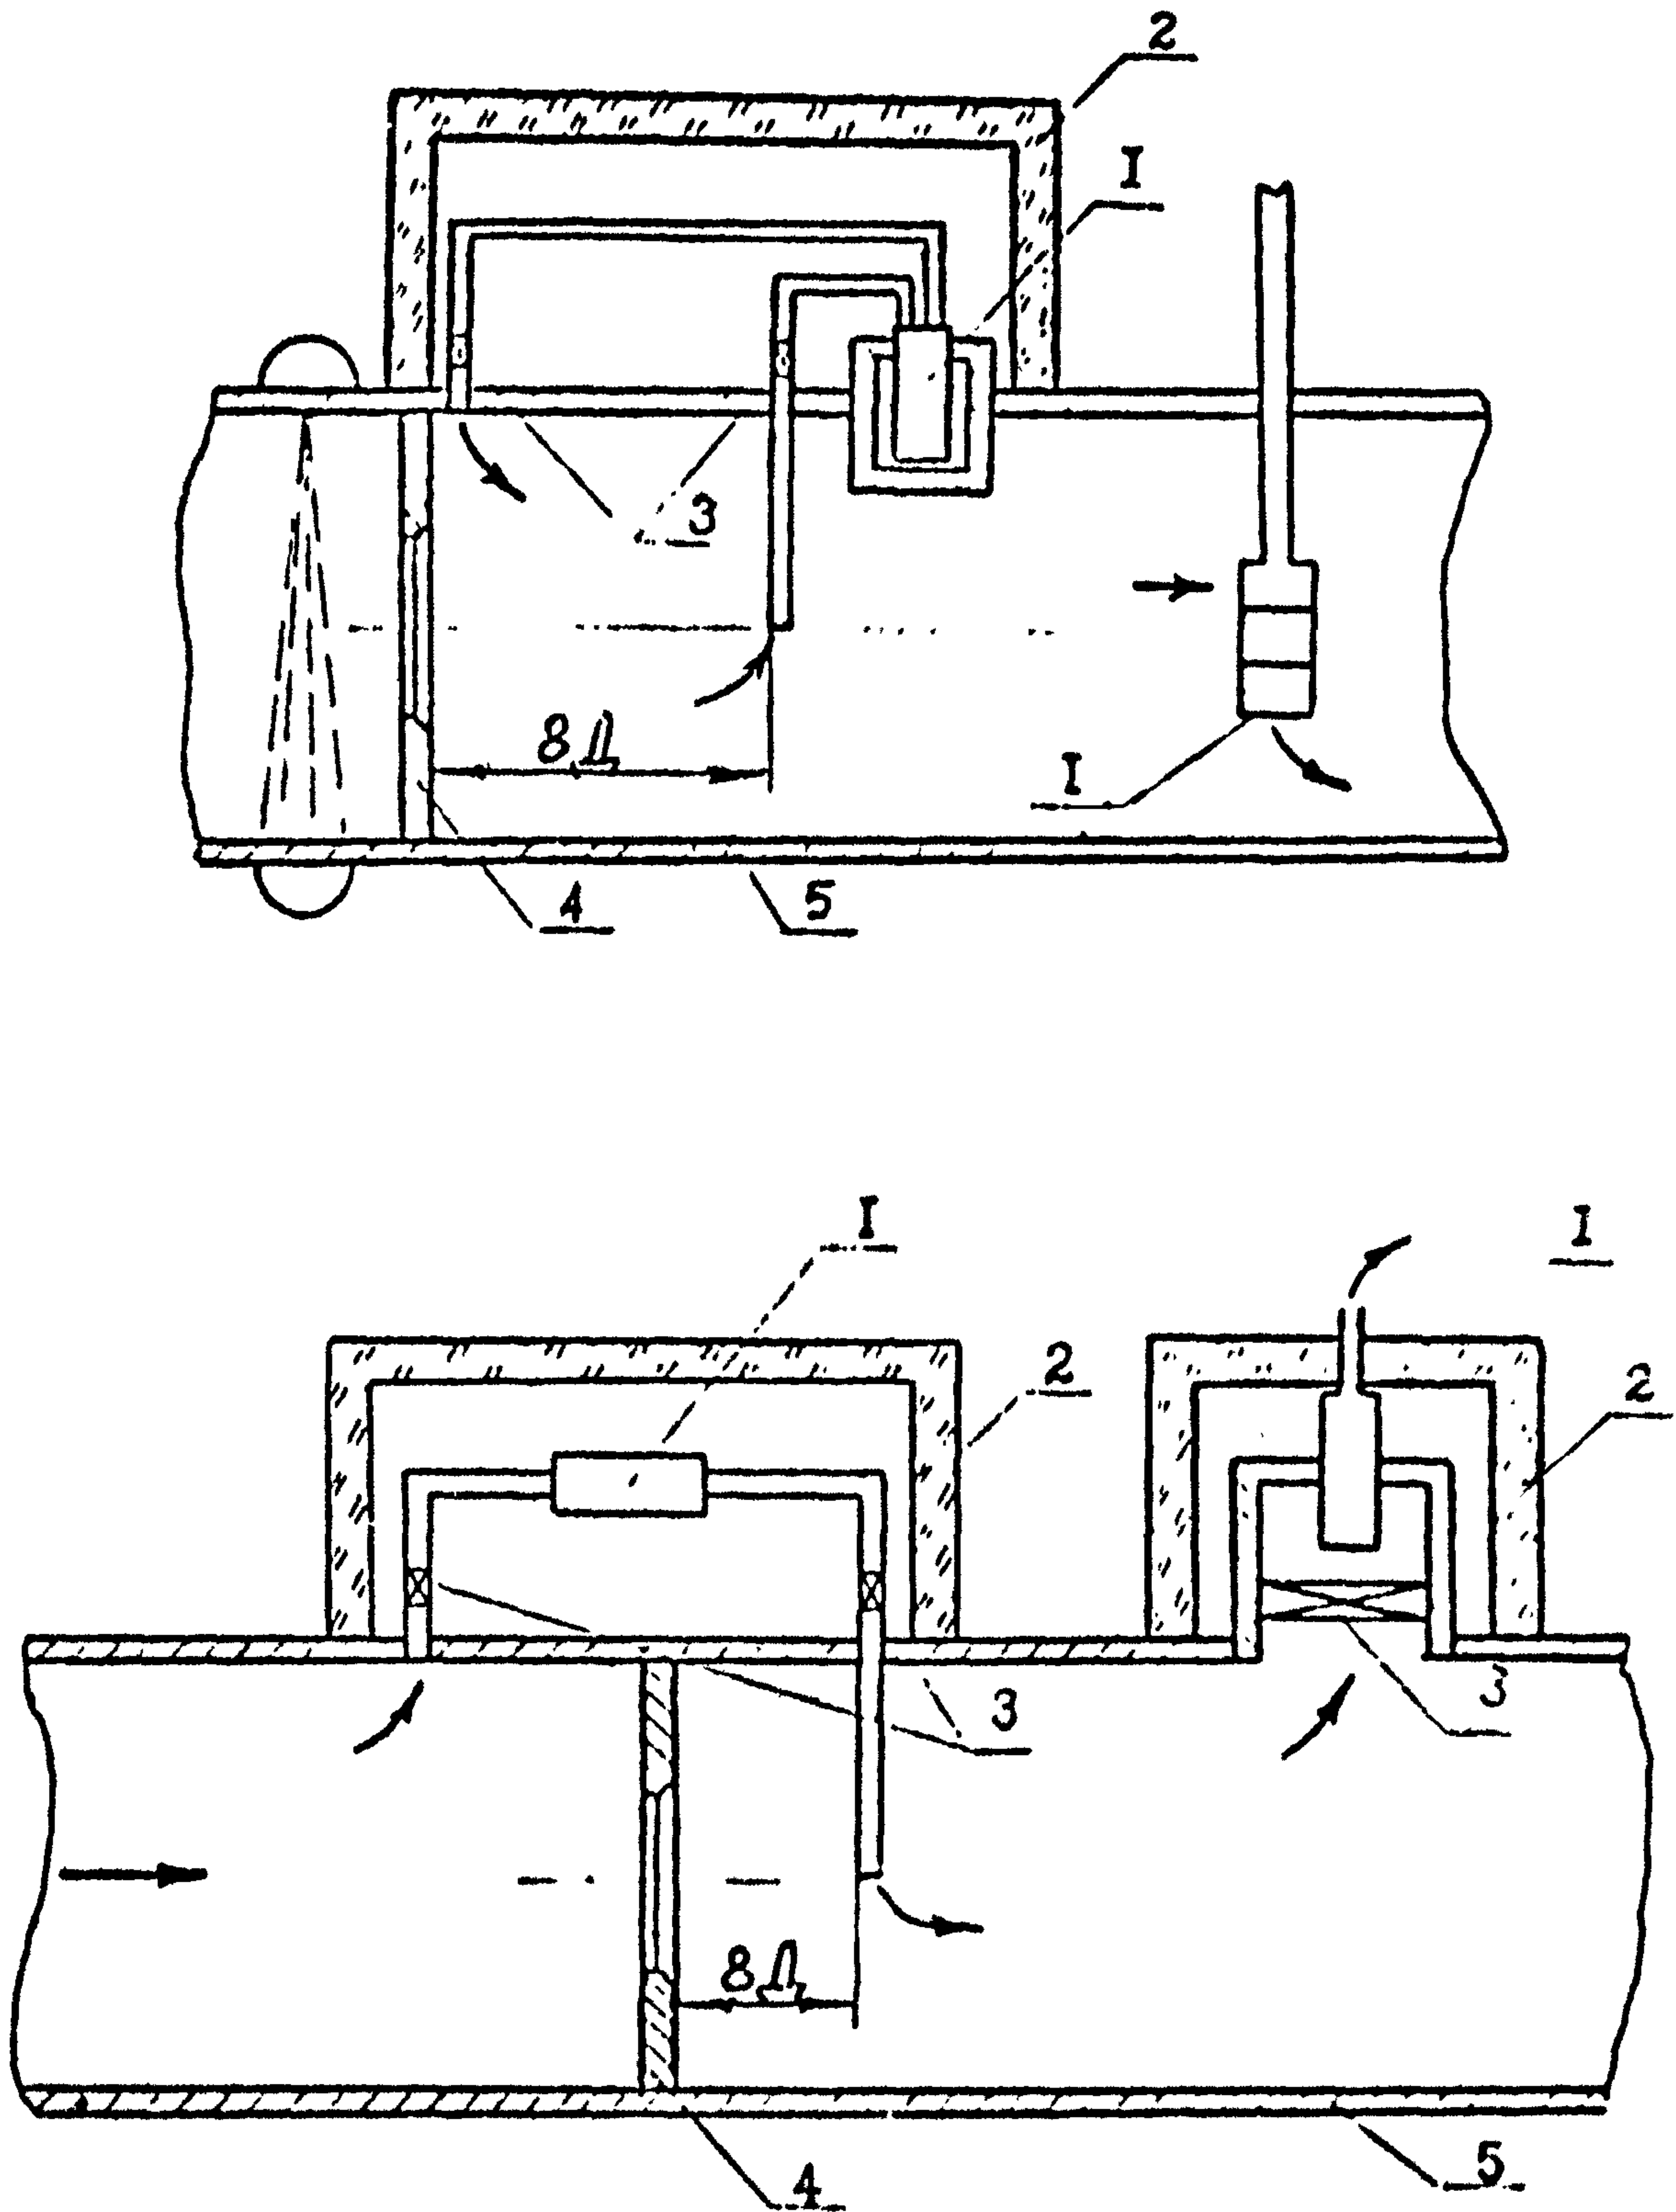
Схема установки плотномеров: 1-плотномер; 2-теплоизоляция; 3-вентиль; 4-диафрагма; 5-трубопровод
